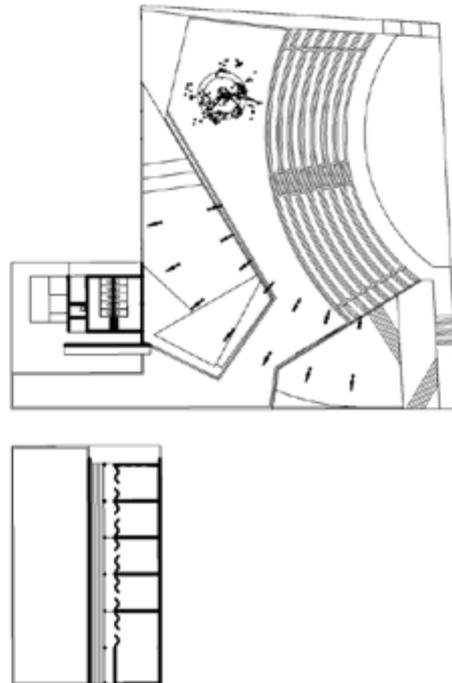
5. Gambar Skematik Denah Lt 2 site 1 sumber (Penulis, 2020)
